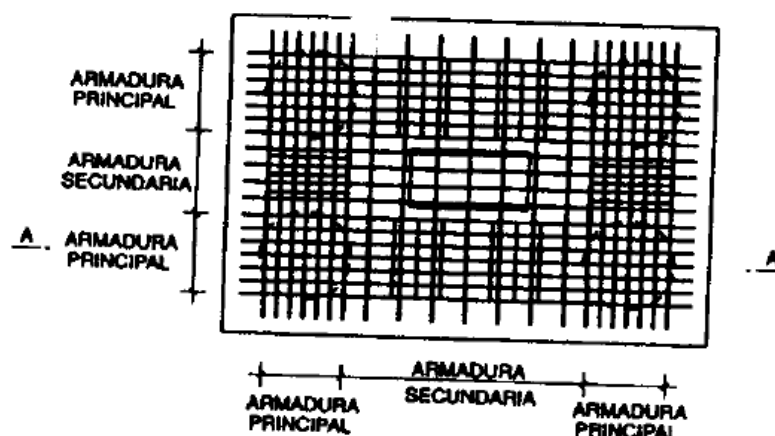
Armaduras del cabezal de un grupo de cuatro pilotes.
